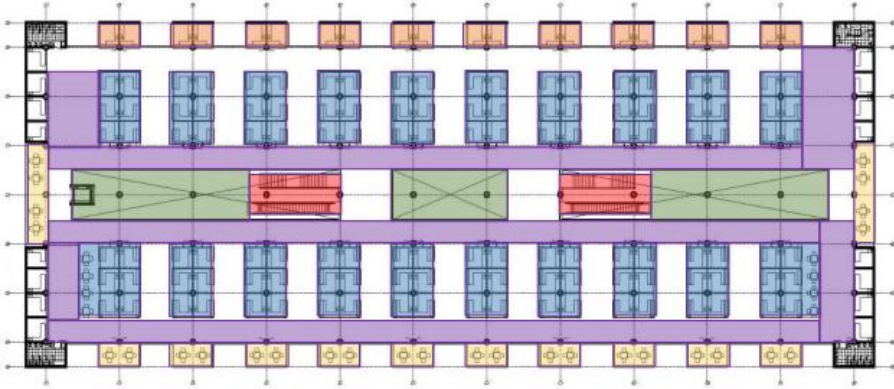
Planta Subsuelo. Fuente: Iglésis Prat arquitectos, 2011, plataforma arquitectura, tomado, el 20/05/2023
